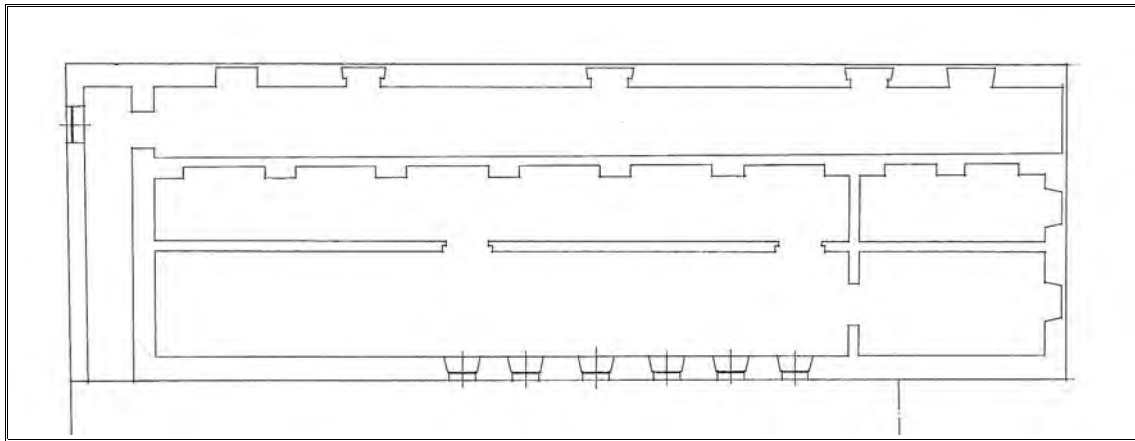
Planta baja del cuerpo del siglo XVII-XVIII. Estado anterior a la intervención de Luca de Tena. (APEALT, Carlos Luca de Tena, *Proyecto para Biblioteca Pública 2ª Fase*, detalle del Plano núm. 2, 1983).
